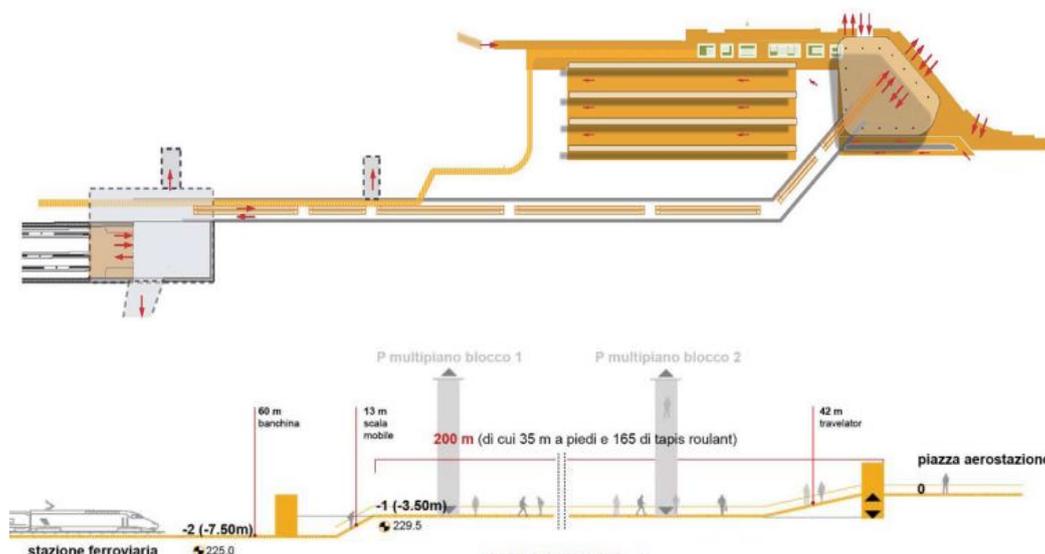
Intervento A1: Collegamento sotterraneo stazione ferroviaria, layout
